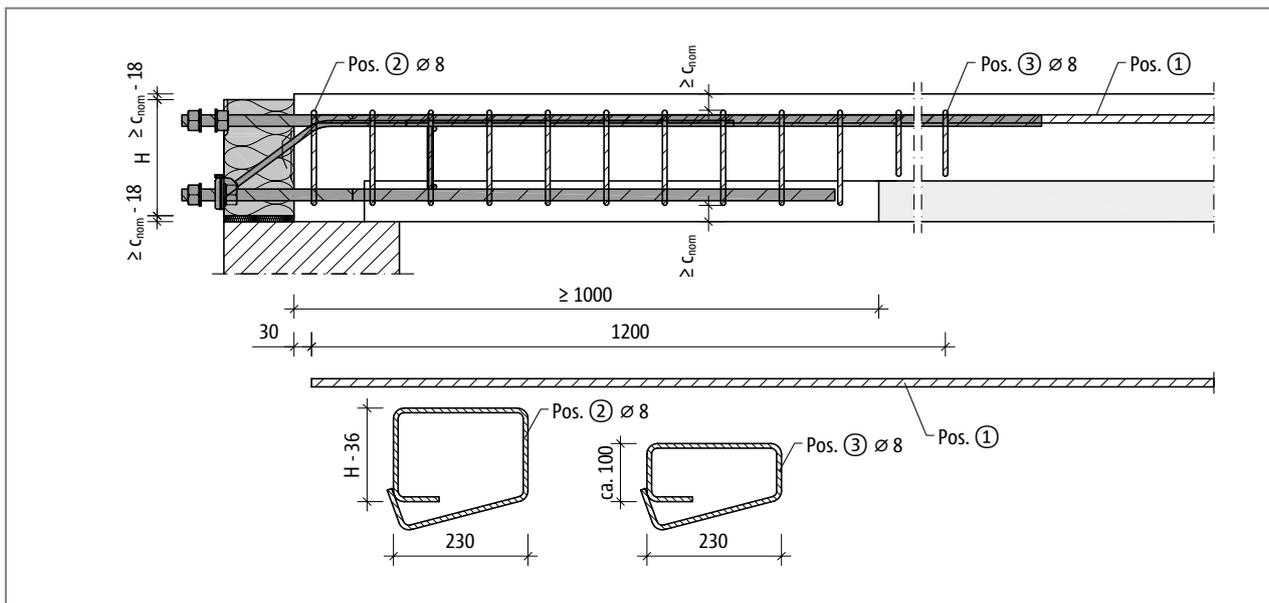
Schöck Isokorb® XT Typ SK-MM2: Bauseitige Bewehrung bei Fertigteilbauweise mit Bügel  $\varnothing 8$  mm; Schnitt
